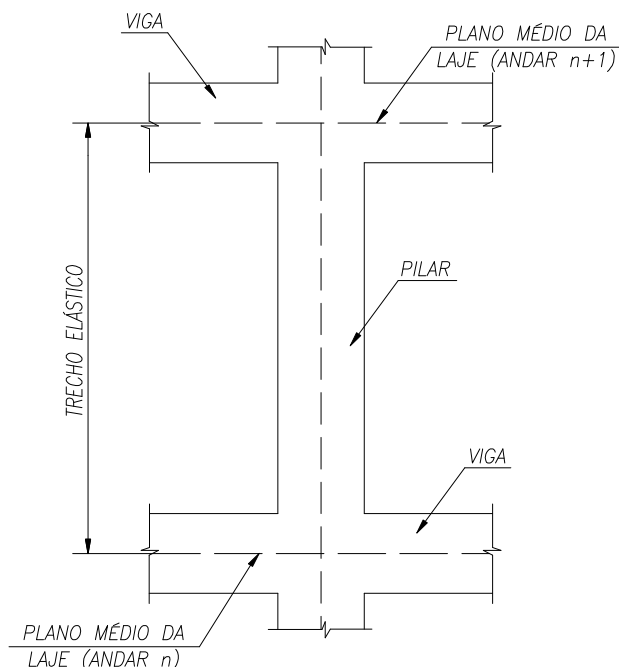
Trecho de Um Pilar Entre Dois Andares
